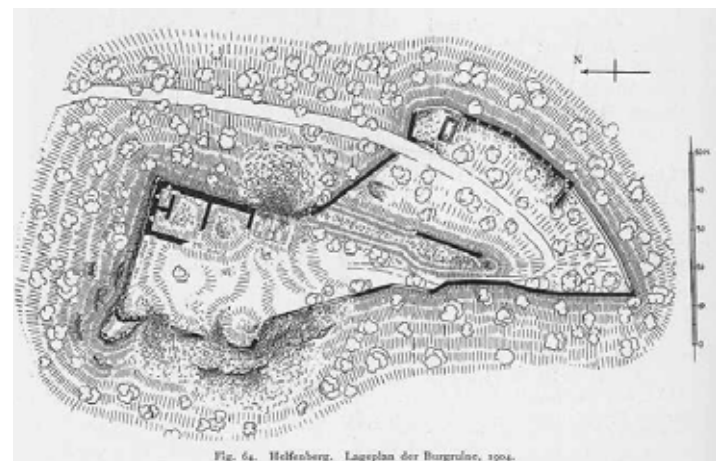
Helfenberg. Lageplan der Burgruine, 1904.
